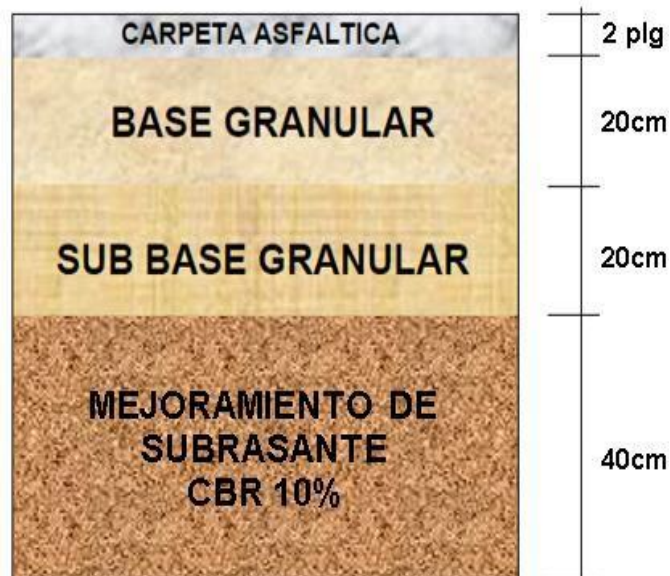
Diseño de pavimento con mejoramiento por reemplazo.
